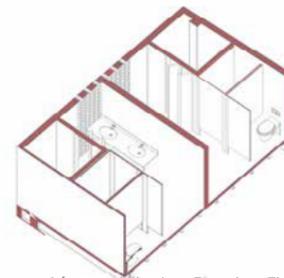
Axonometrías explotadas Fuente: Elaboración propia
